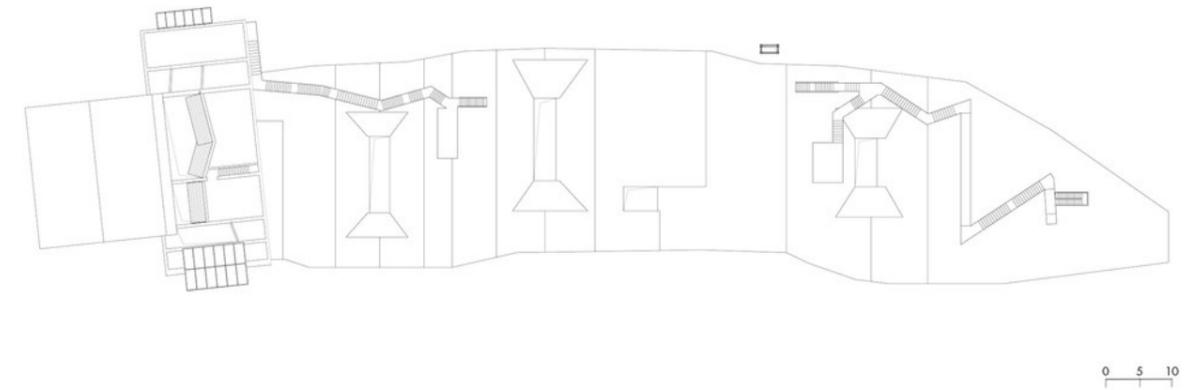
134. Planta de cubierta del proyecto. (Imagen extraída en red: área-arch.it).
